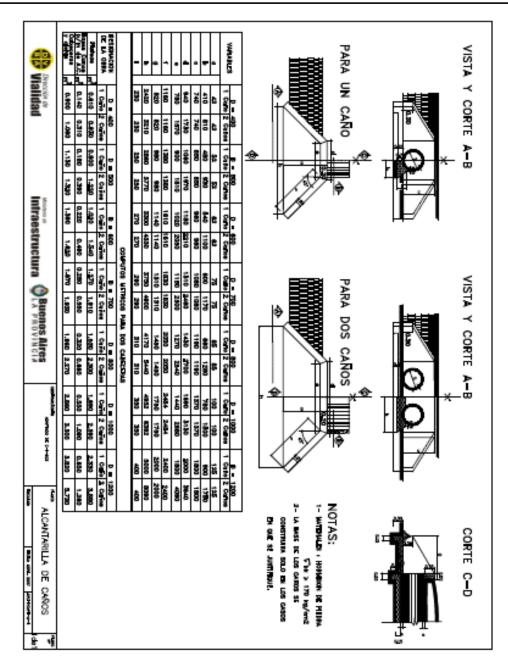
Plano Tipo Alcantarilla de Caños de la Dirección Nacional de Vialidad
